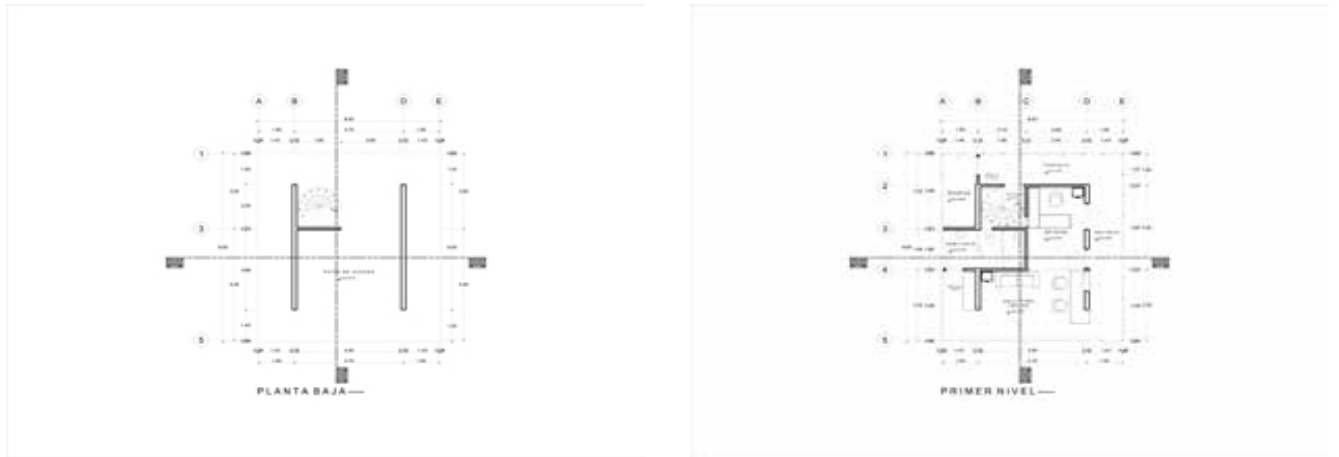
Planta baja y Primer nivel del proyecto de una Caseta de Vigilancia en la UAM Azcapotzalco
